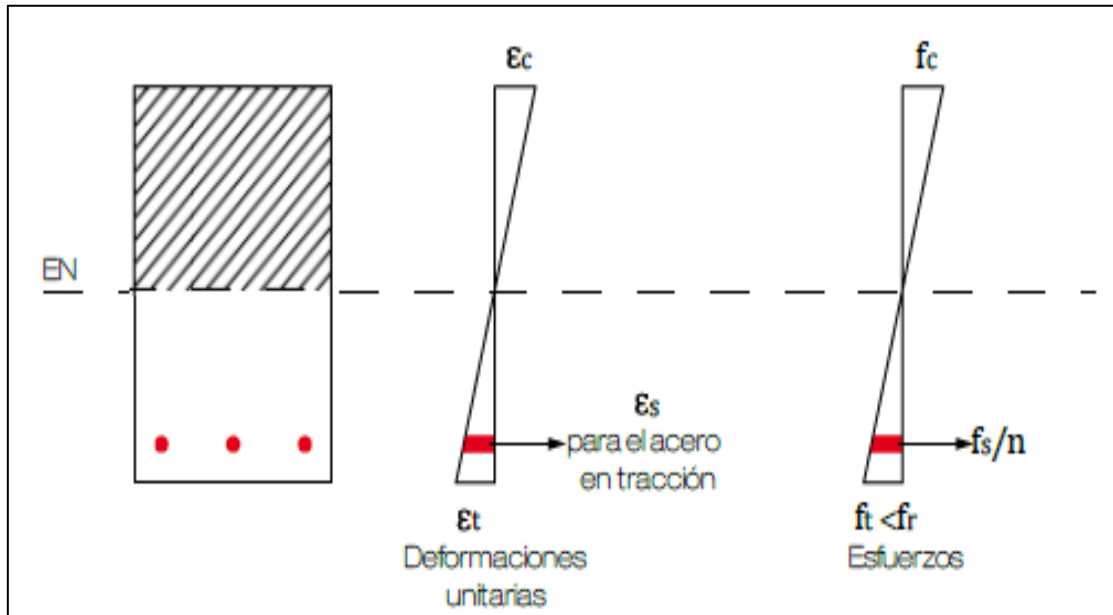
Esfuerzos y deformaciones en viga de concreto no agrietado.
